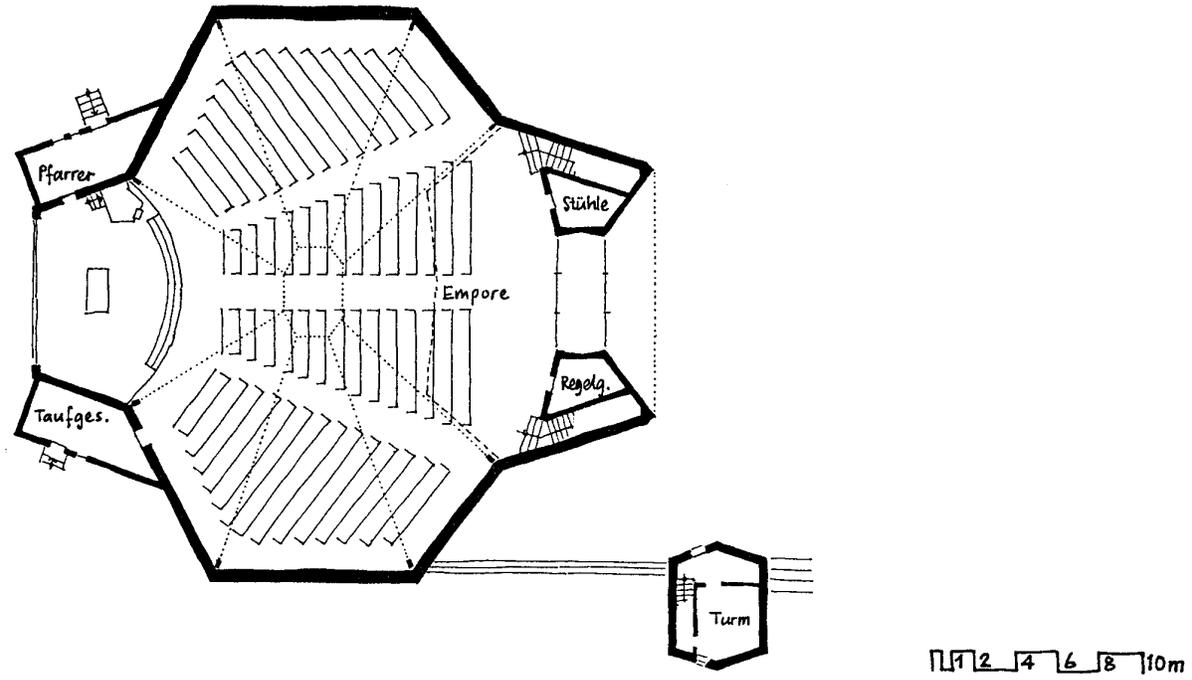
Grundriss evangelische Kirche Wil
